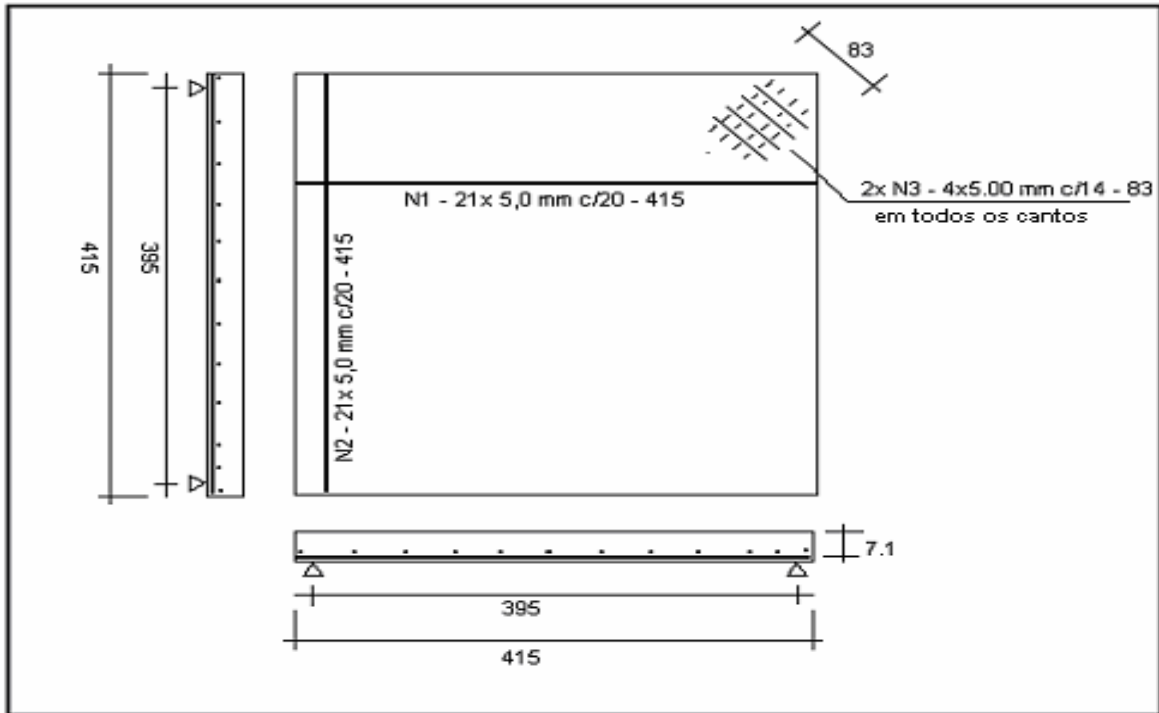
Dimensões, detalhamento das armaduras e apoios das lajes ensaiadas por Campos (2000)
